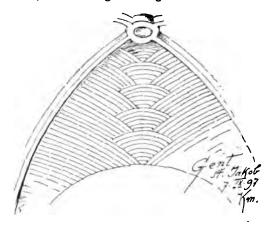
Nahtbildung durch eingeschobene Gewölbchen.
